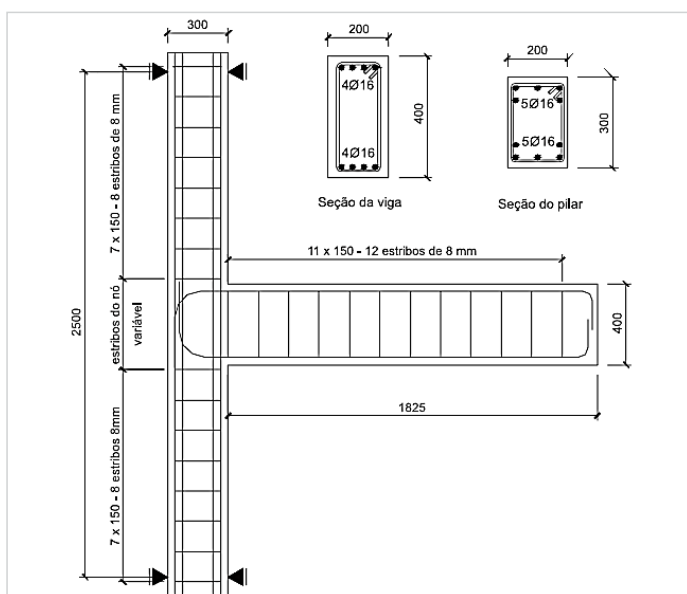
Detalhamento da geometria e das armaduras empregadas nas ligações (mm)
